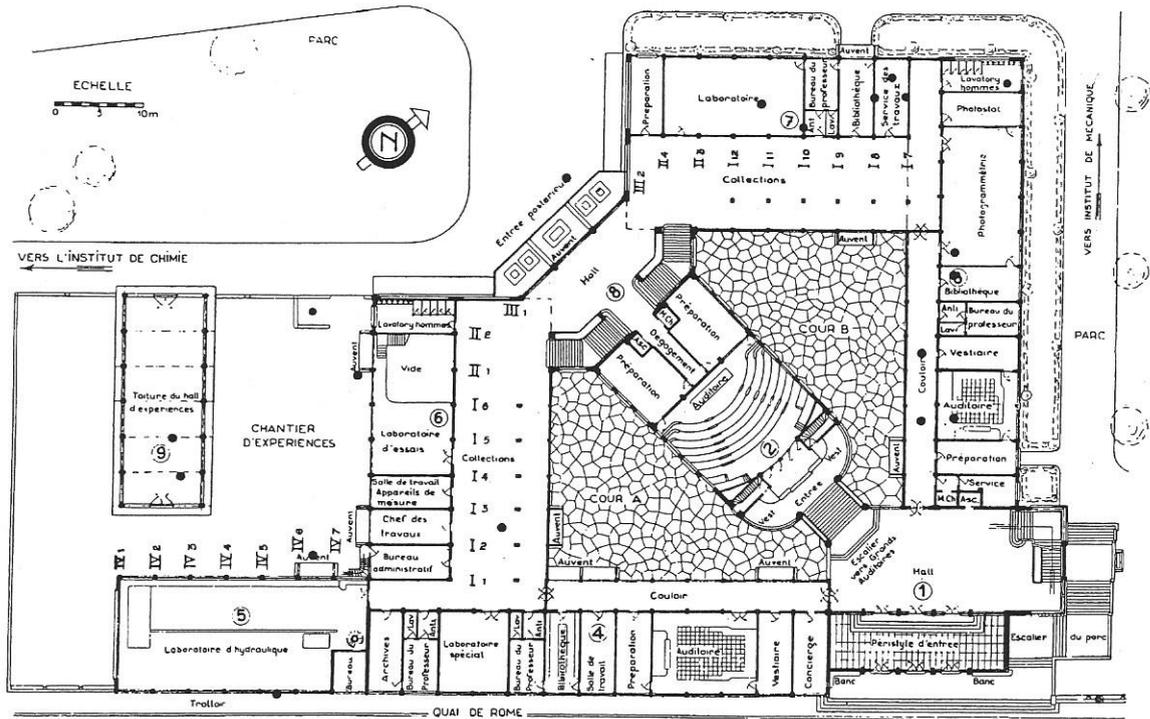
Plan d'ensemble des instituts universitaires du Val-Benoît (Liège).
